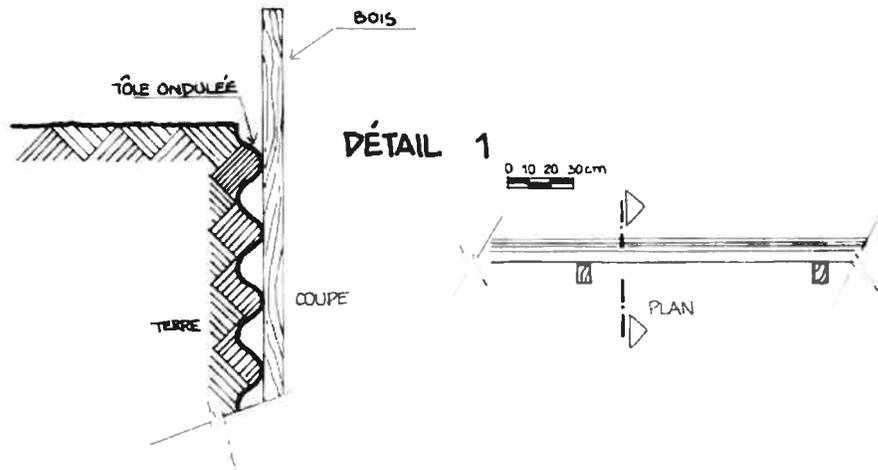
Plan et coupe de la baraque 8 étudiée à Jamaica
